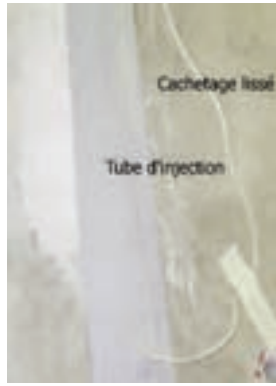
cachetage en bande et lissé (crédit photo Poinneau)
